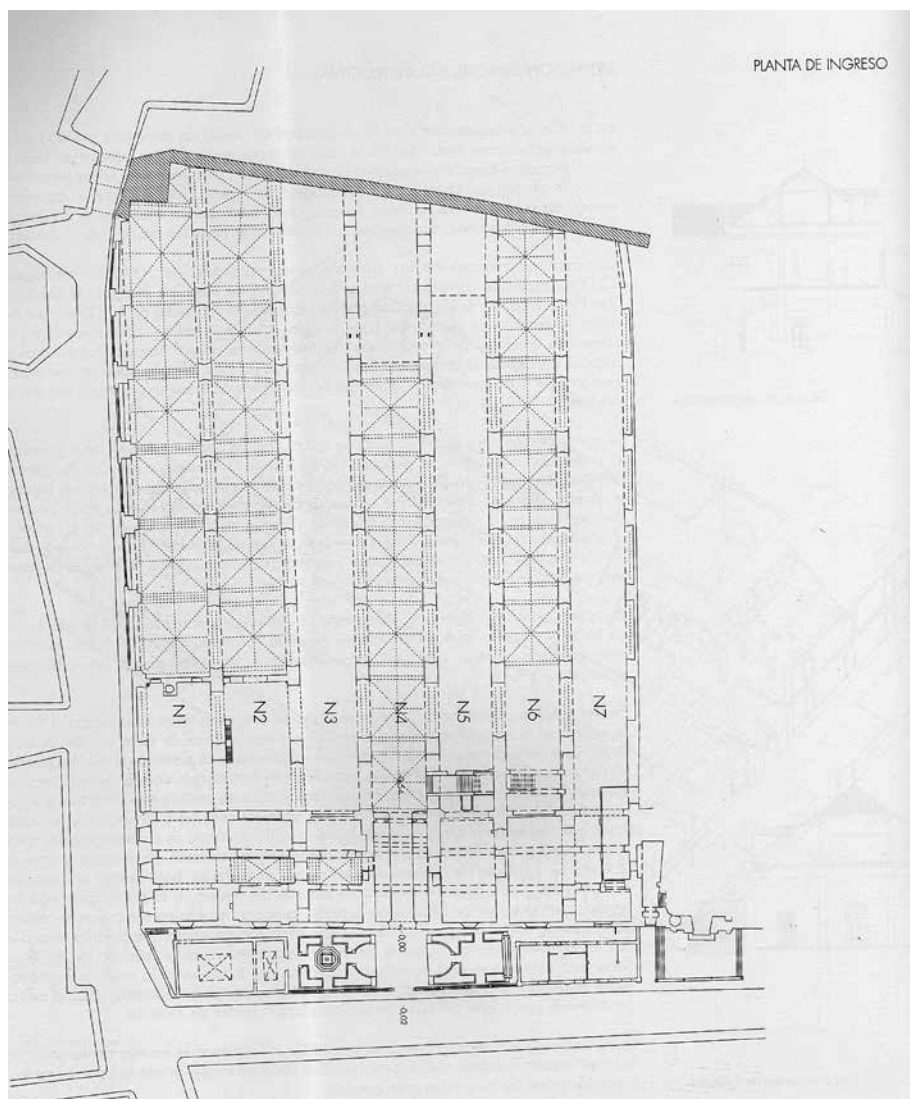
Planta de las siete naves correspondientes a la Maestranza de Artillería (A. Barrionuevo).
